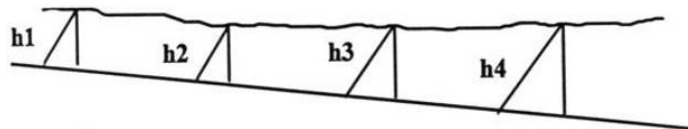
Perfil de la tubería de drenaje y el terreno
